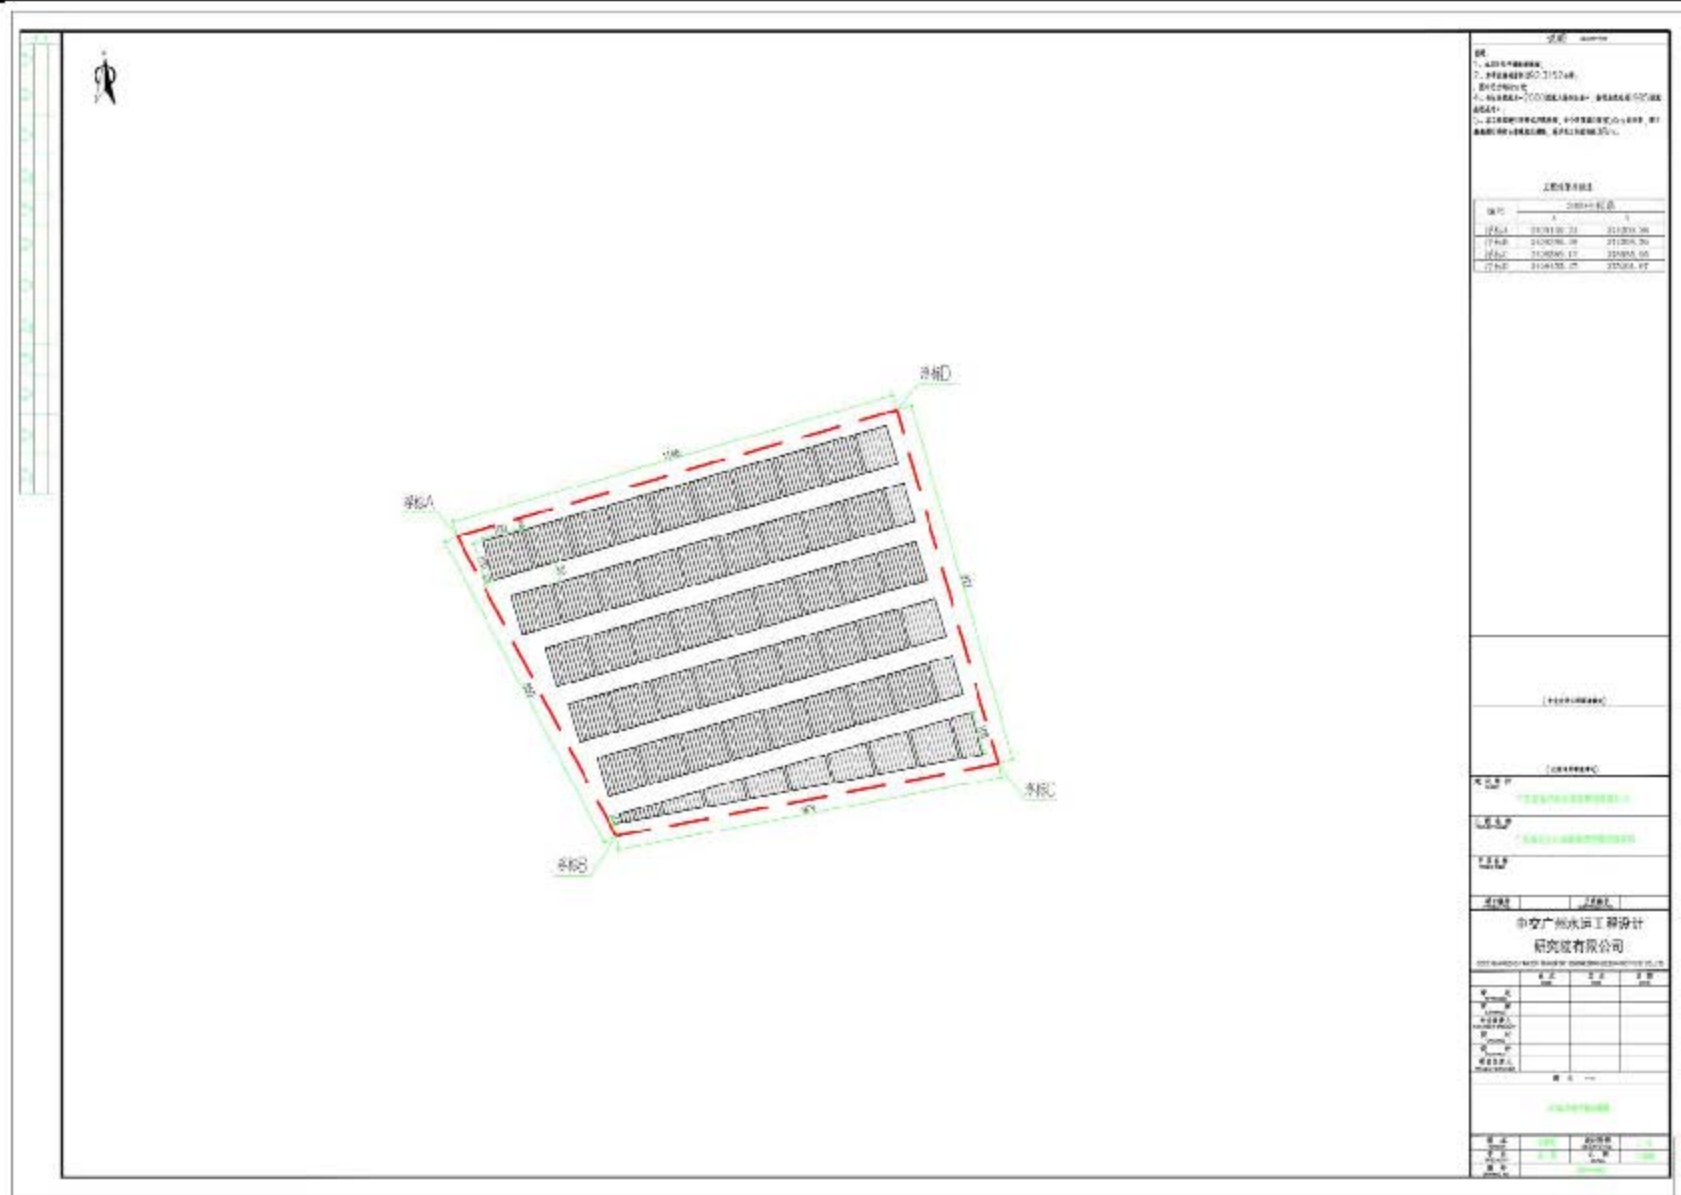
区域 2 平面布置图 (浮网式浮筏养殖)
